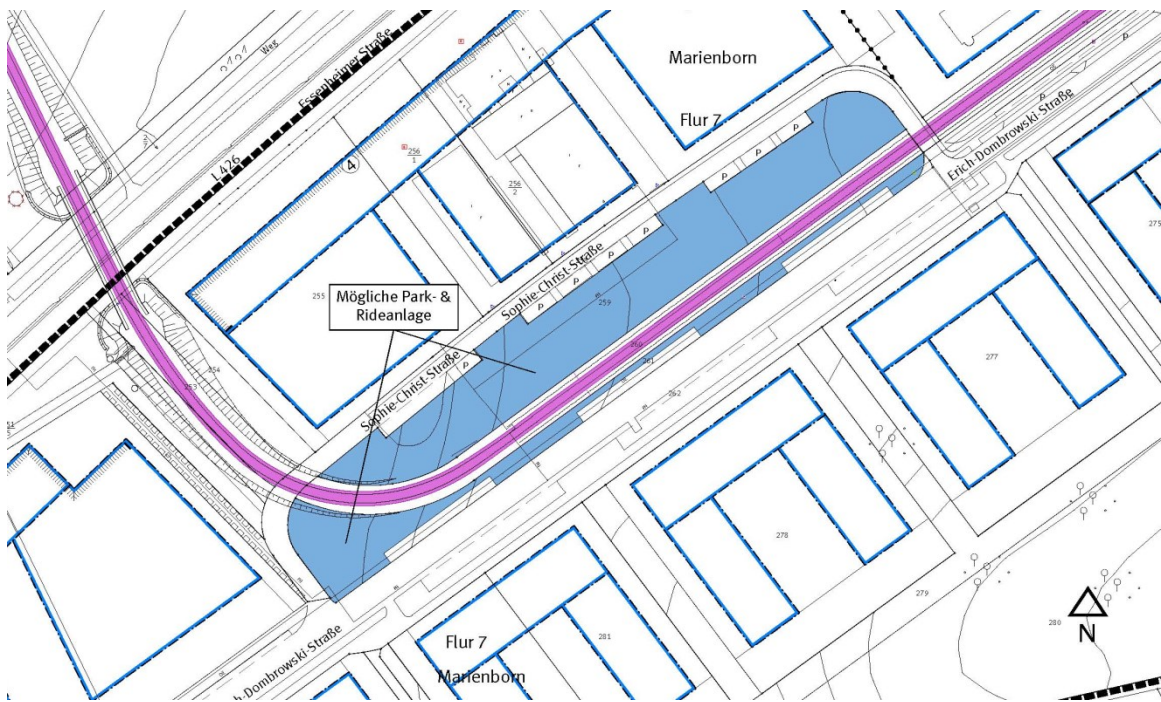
Mögliche Fläche für eine P+R-Anlage im Bebauungsplan Ma 30
